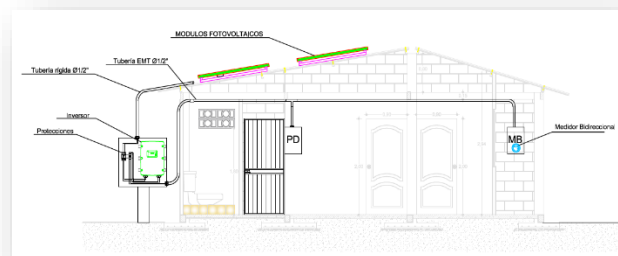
Implantación del s.f.v. conectado a la red en AutoCAD.
